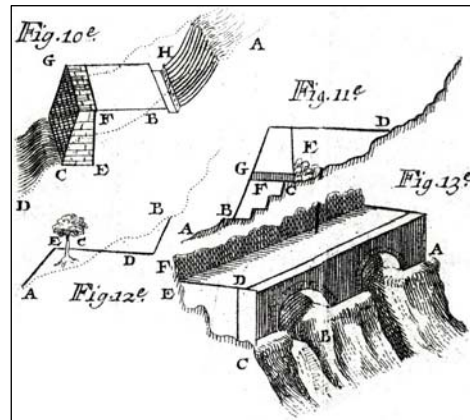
Secciones a media ladera propuestas por Gautier. Para pasar los barrancos se proponía la construcción de arcos en vez de muros.
